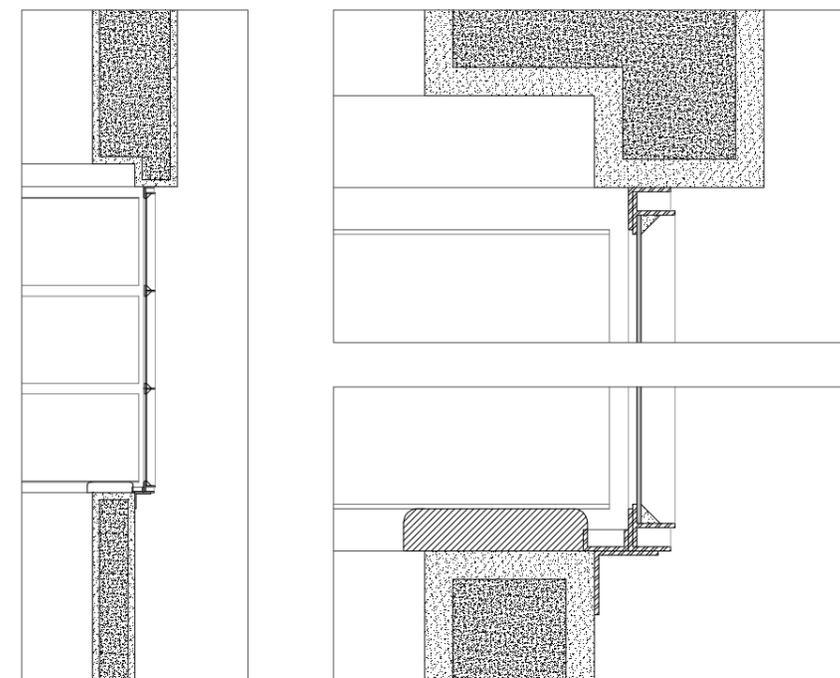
Perfil da Bow Window do Piso 1 — Desenho Original | Escalas 1:20 e 1:5
